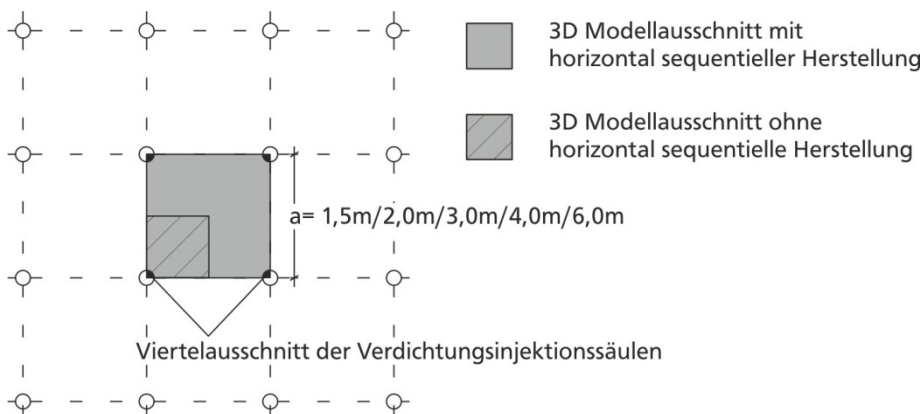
Grundriss des 3D-Modells mit horizontal sequenzieller Herstellung
